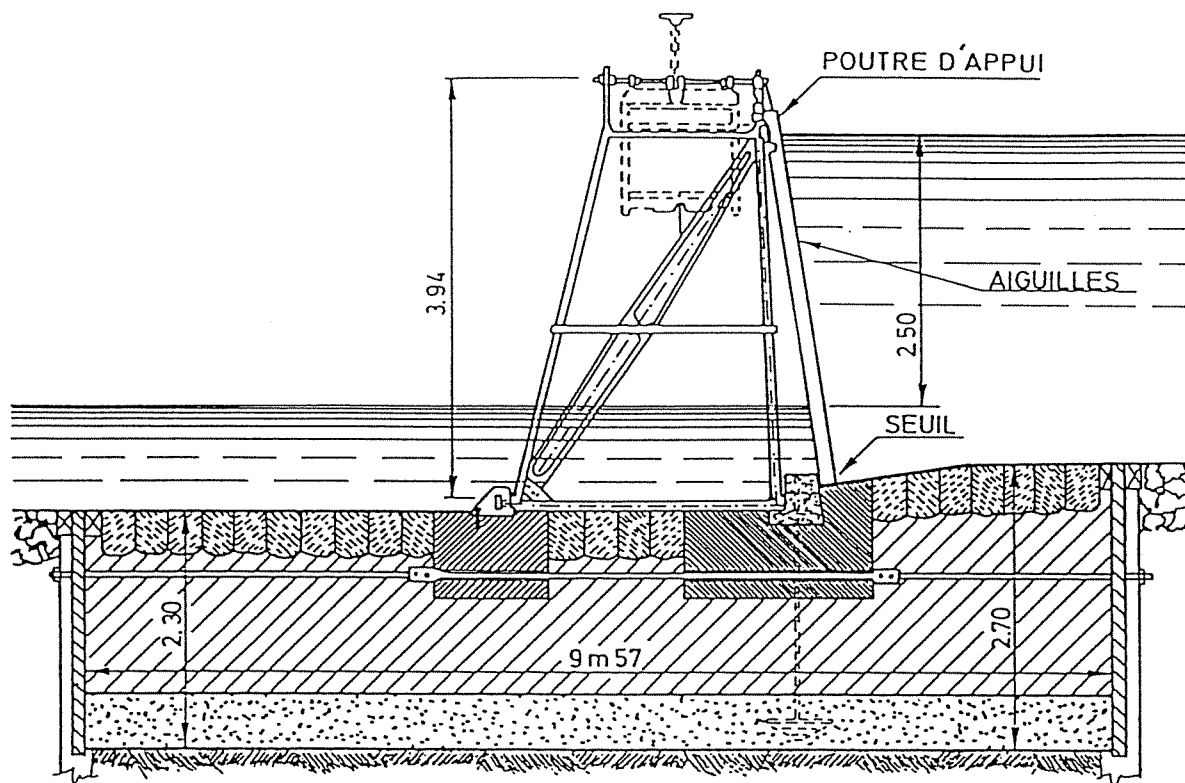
Vue en coupe transversale d'un barrage à fermettes et aiguilles
